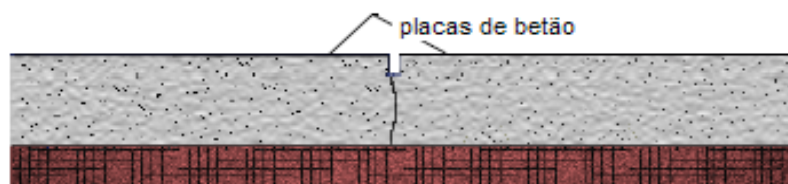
Perfil de um pavimento rígido em betão simples sem barras de transferência (Oliveira 2000)
